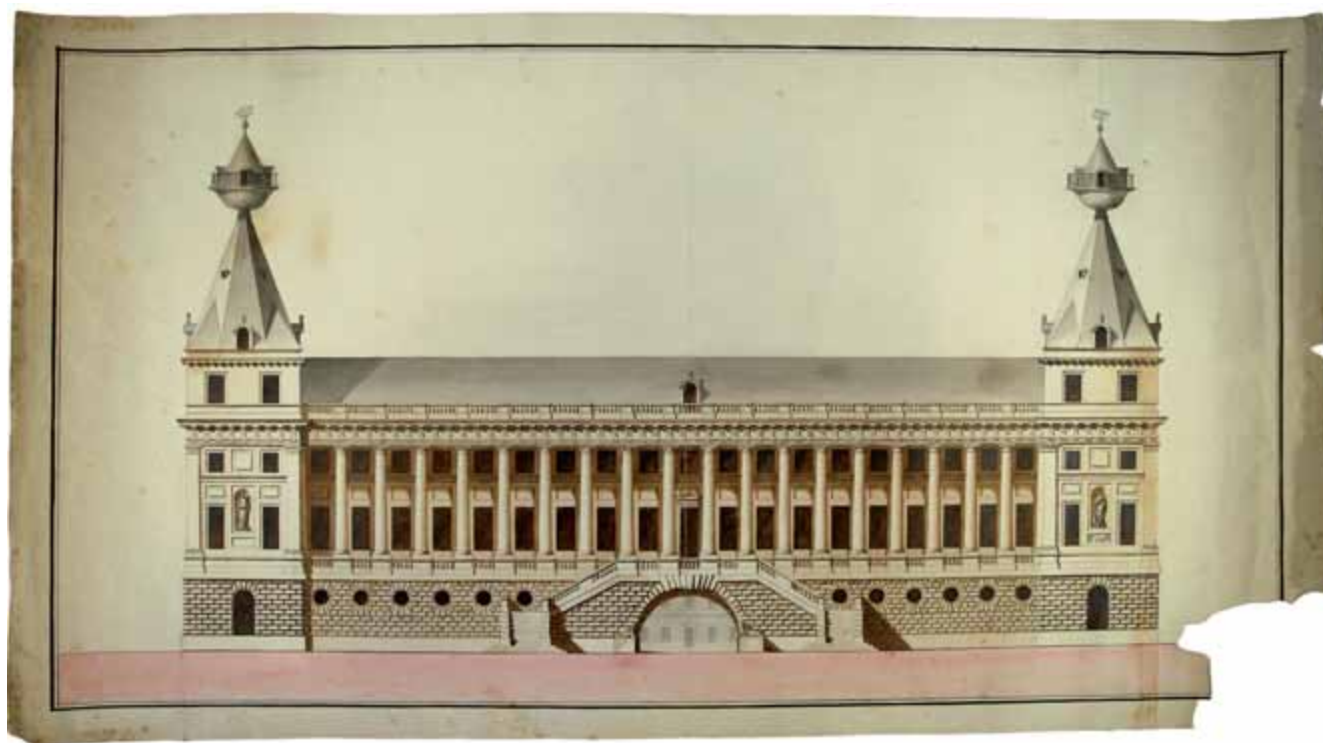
Projet final pour la façade du château d'Heverlee (Archives Générales du Royaume).
